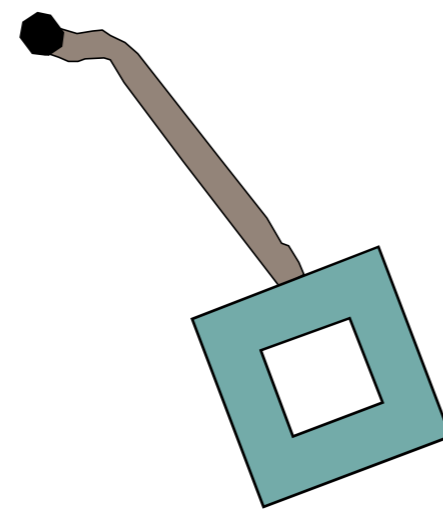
Croquis en planta del Faro de Cabo Vilán.
